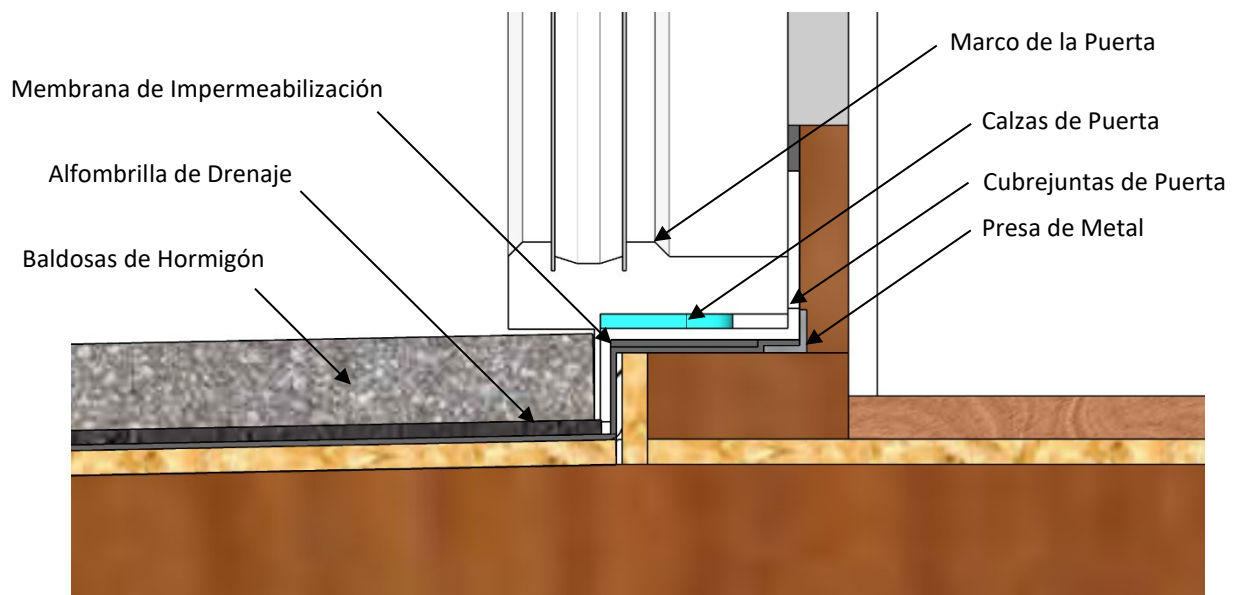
Principio Dos: Cubrejuntas y Drenaje
